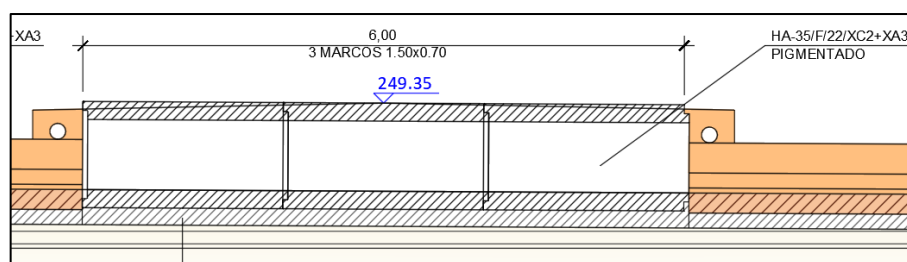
Vista de los marcos de hormigón pigmentados en el acceso de la rampa.
